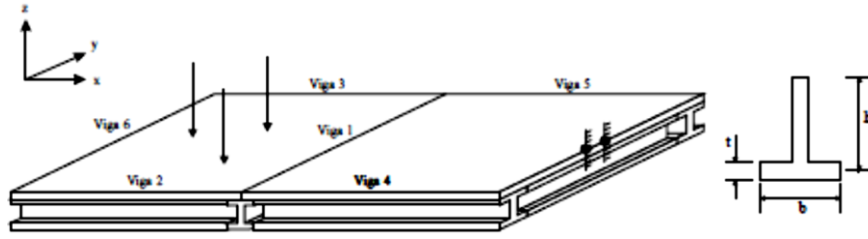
Arranjo entre placas apoiadas em vigas para determinação dos CLF pelo FEM.
